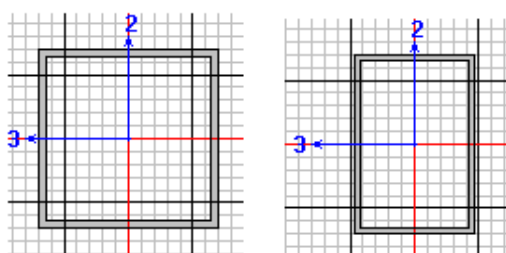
Sección transversal de los elementos estructurales (columna a la izquierda y viga a la derecha).
